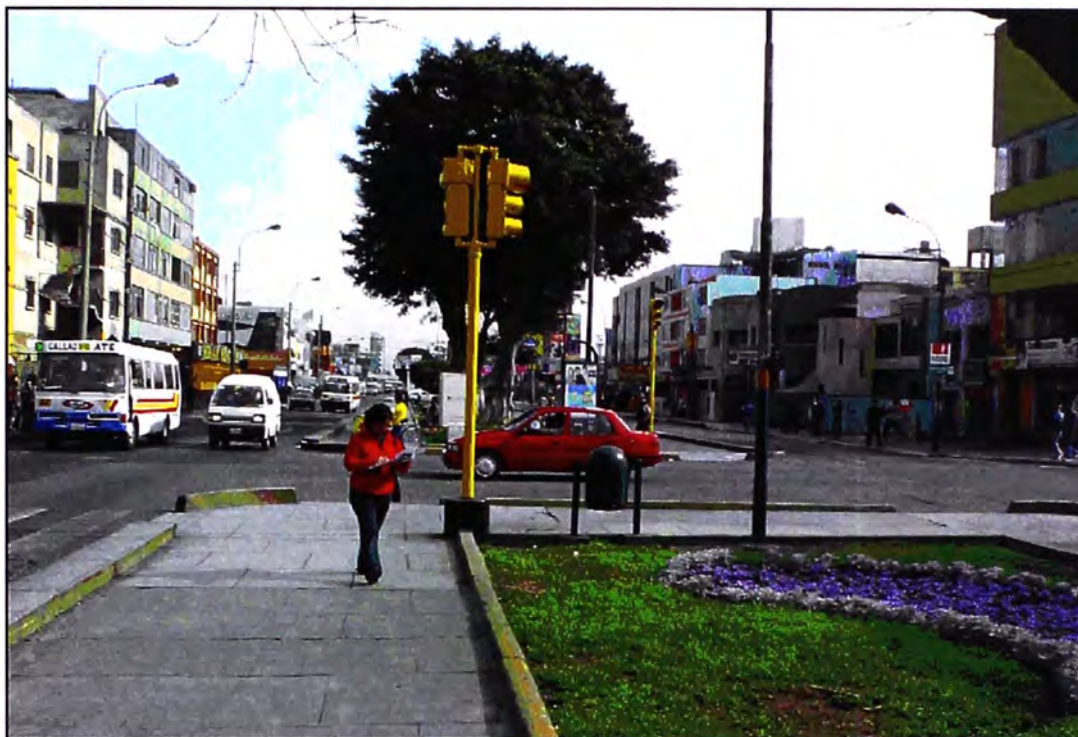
Sección Típica del Separador Central – Av. Arequipa (cdra. 1 hasta cdra. 15)
